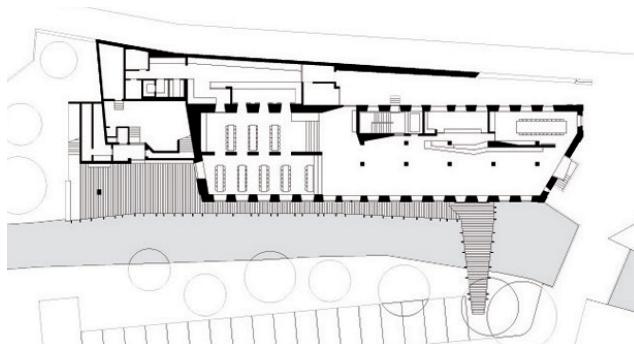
Grundriss EG Jugendherberge St. Alban
